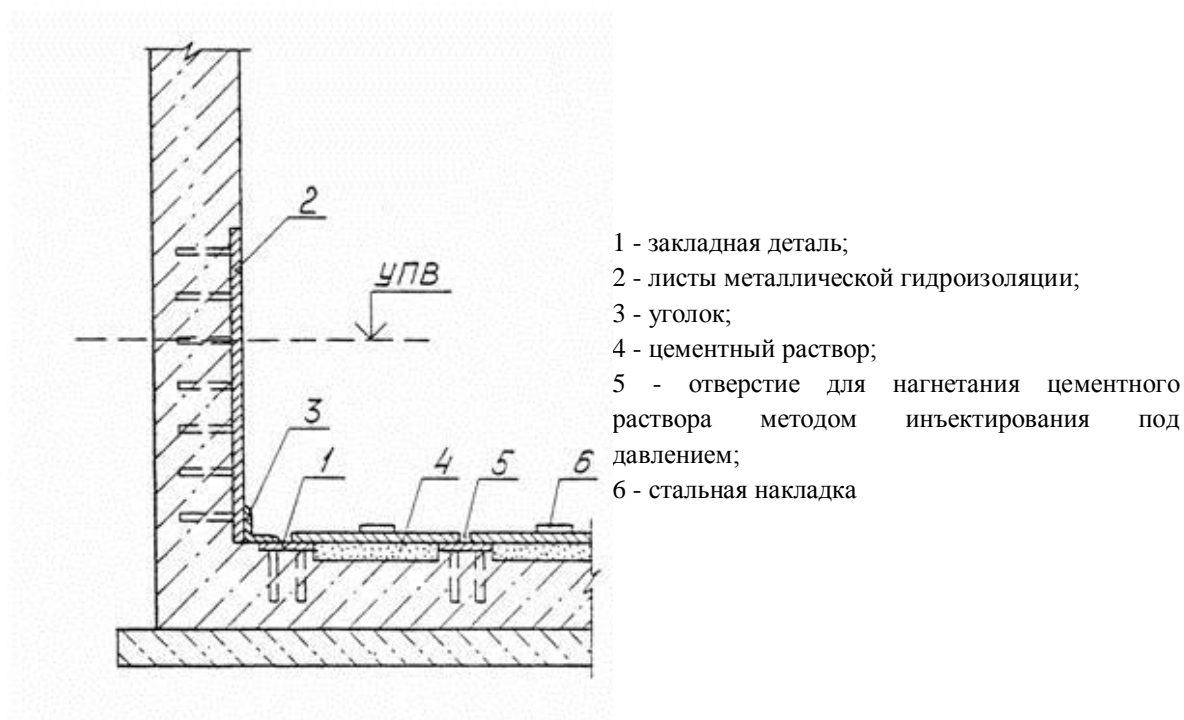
Металлическая гидроизоляция тоннеля при наличии подземных вод
